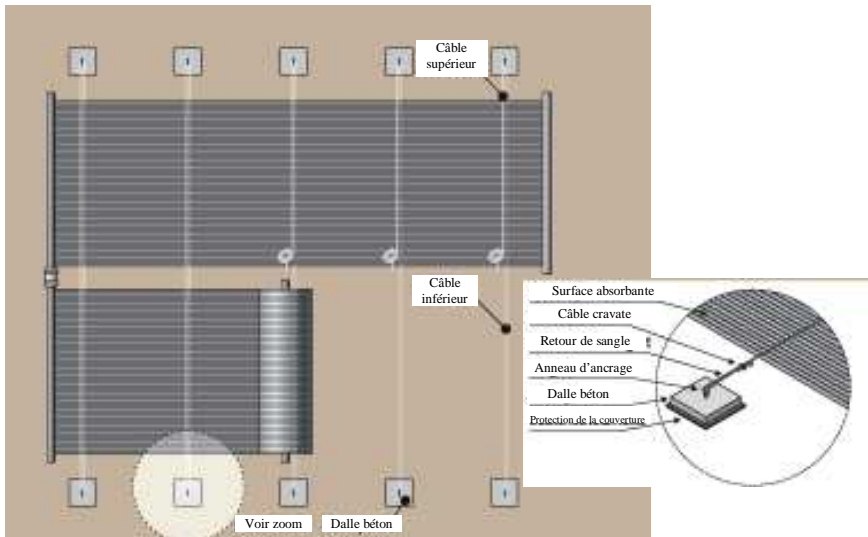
Fixation des capteurs avec des sangles en ceinture sur des dalles de béton à la surface d'une toiture terrasse.
